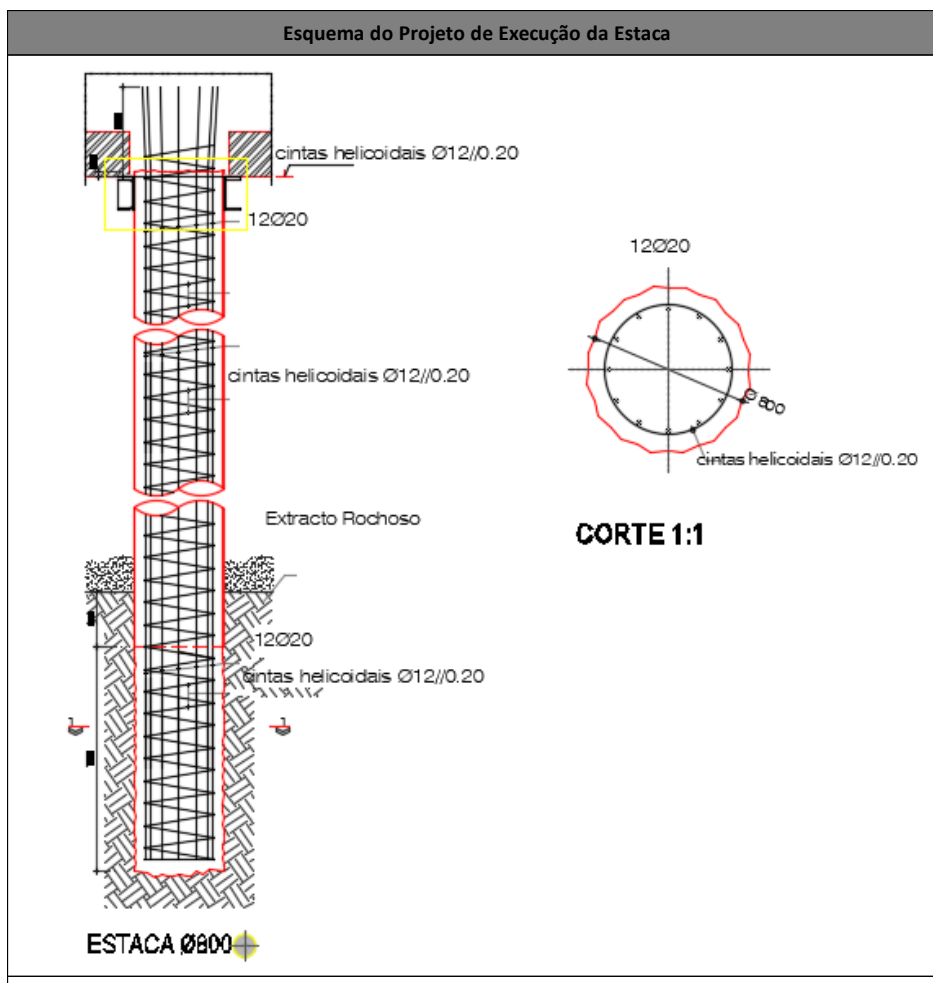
Excerto da ficha técnica - Estacas de betão armado (Porto do Funchal - Cais 6).
